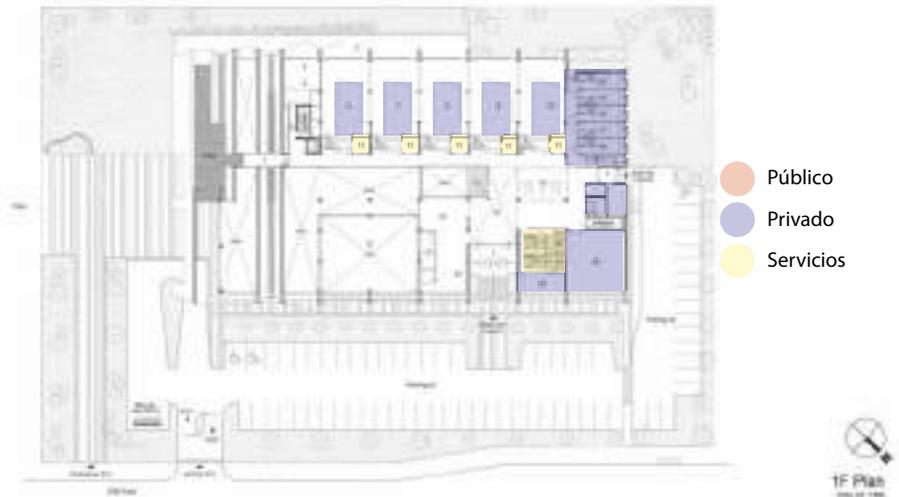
Planta Arquitectónica Segundo Piso - Design Strategy & Research Center. Plano de THE_SYSTEM LAB (Plataforma Arquitectura, 2017)
